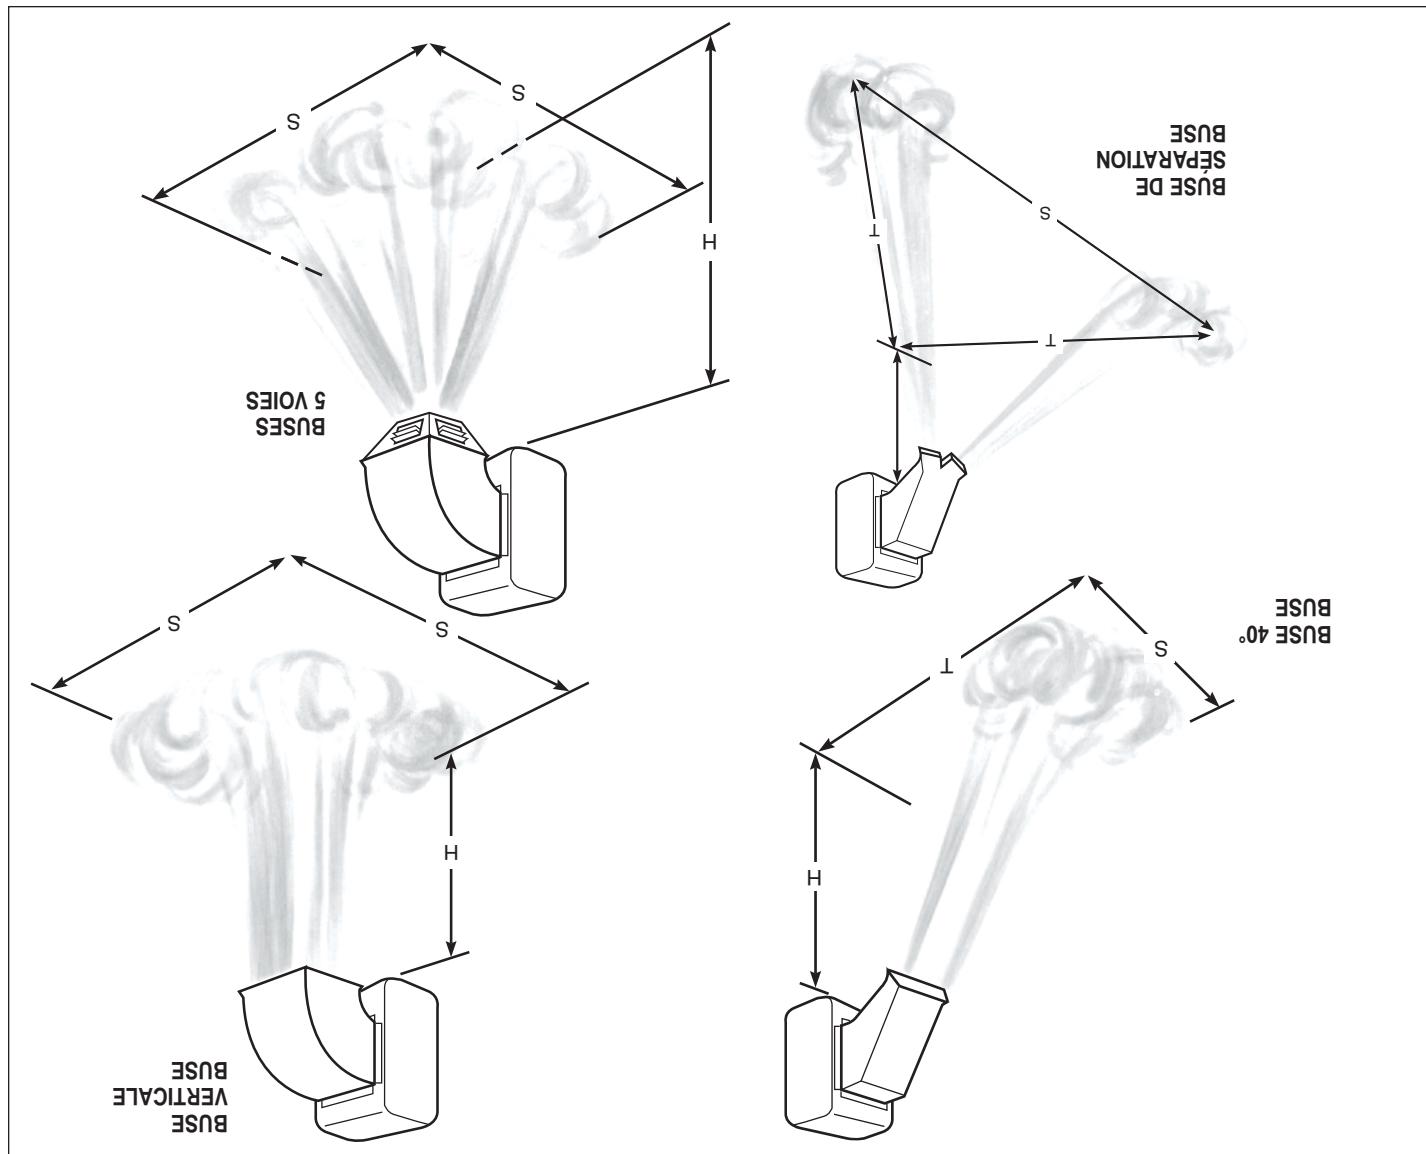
Hauteur de montage, portée et couverture de chauffage (pi)
